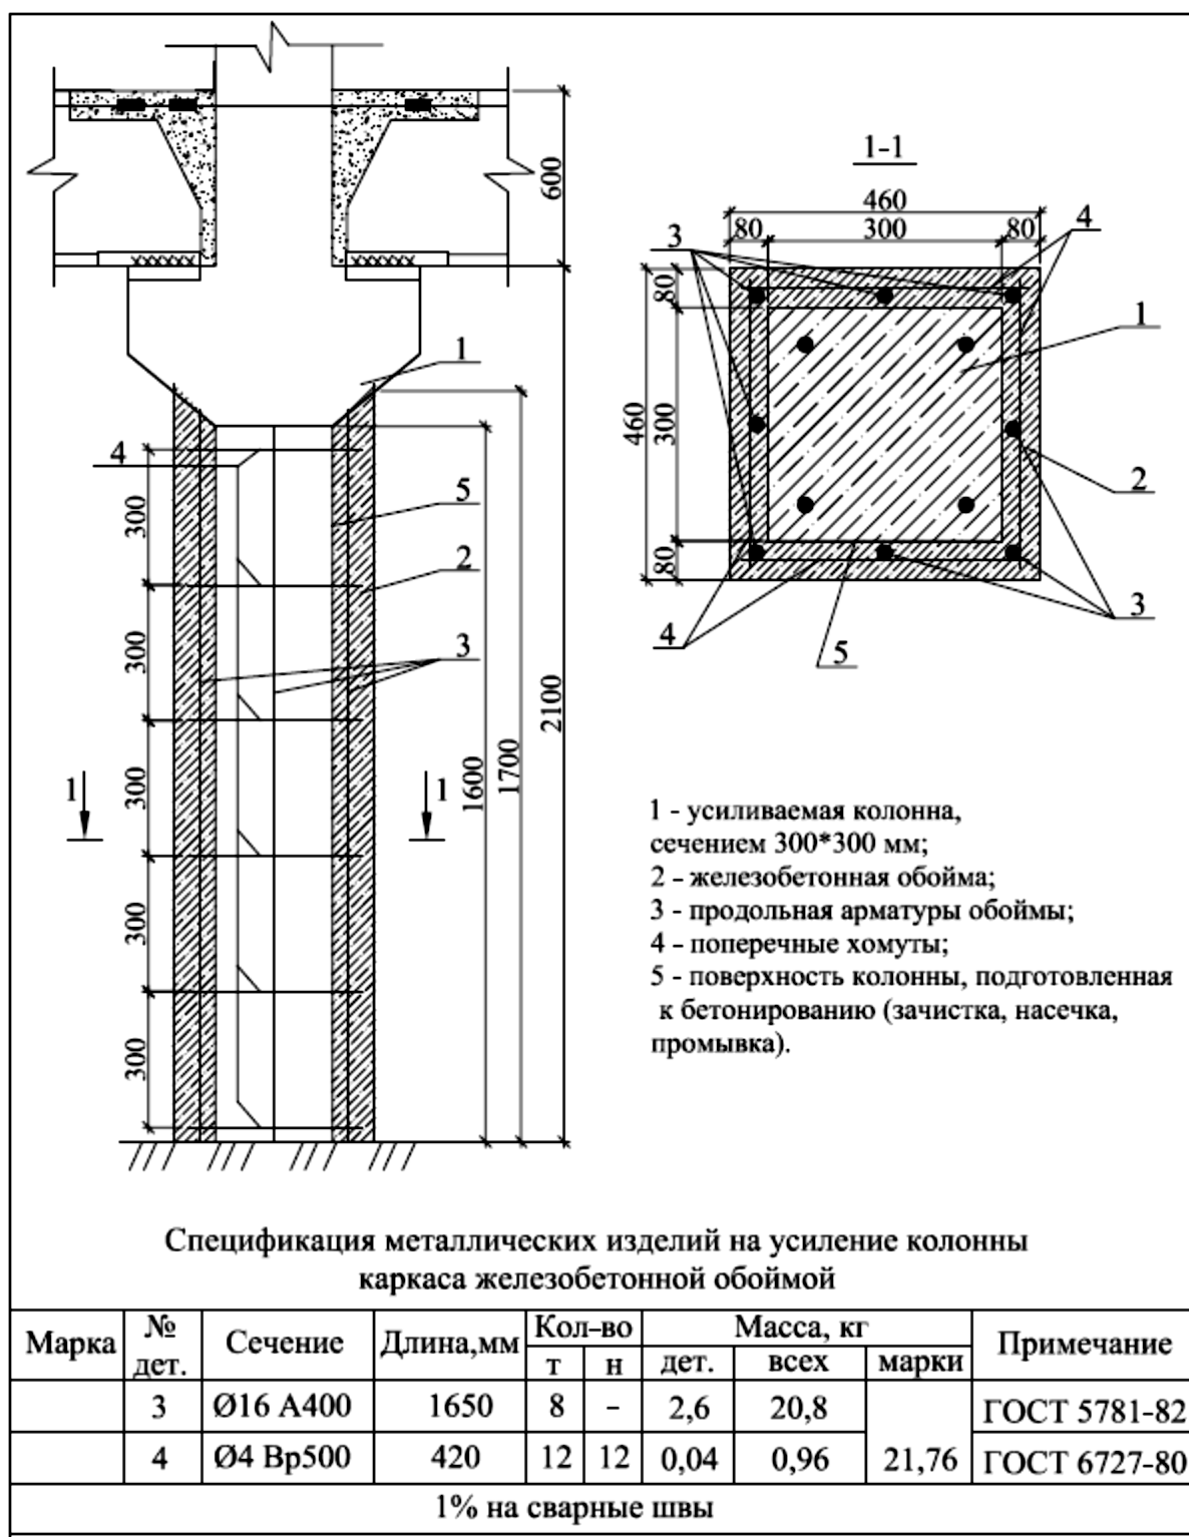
Техническое решение по усилению железобетонной колонны каркаса устройством железобетонной обоймы
